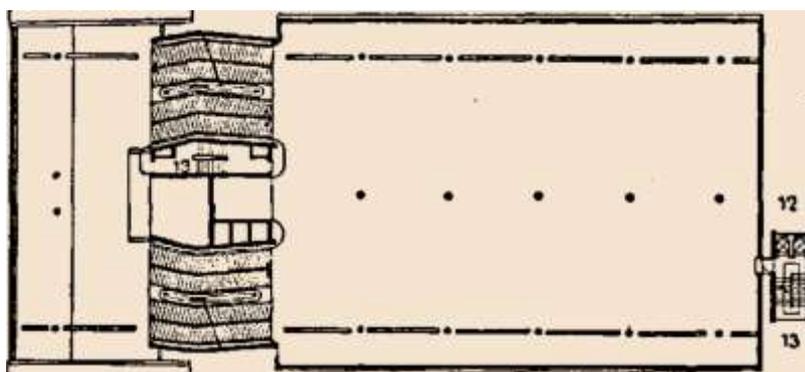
Многоэтажный наземно-подземный гараж «Брейнингер» на 330м/м, г. Штутгарт (ФРГ). Продольный разрез. План кровли.
